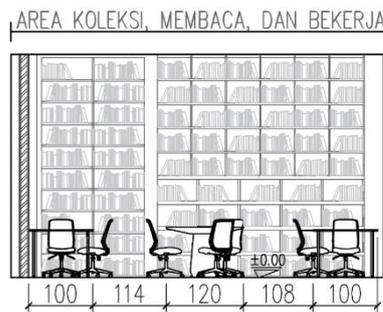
Denah Area Baca, Kerja dan Koleksi 2
